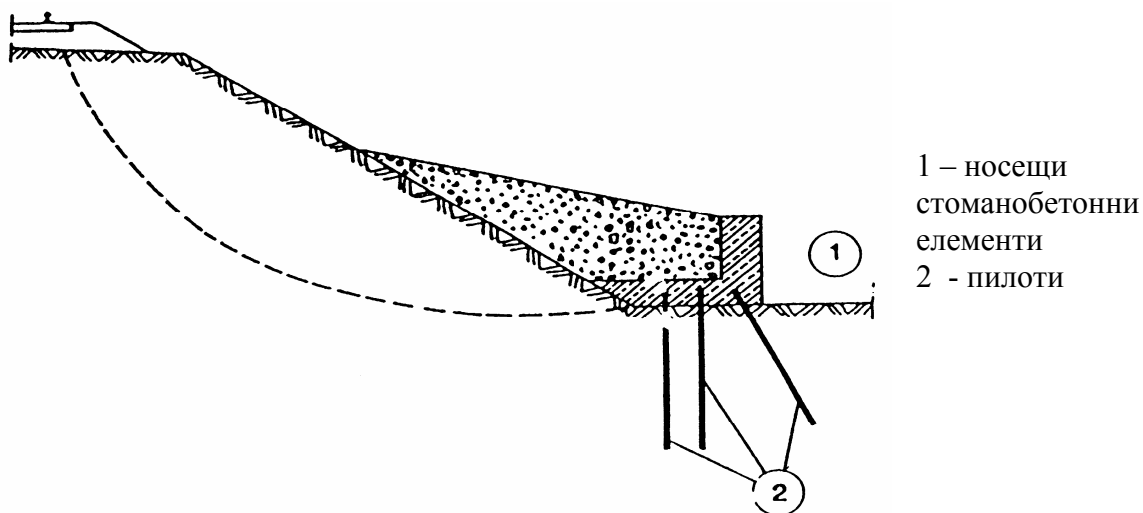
Укрепване на откоси чрез облицоване с бетонни или стоманобетонни елементи
